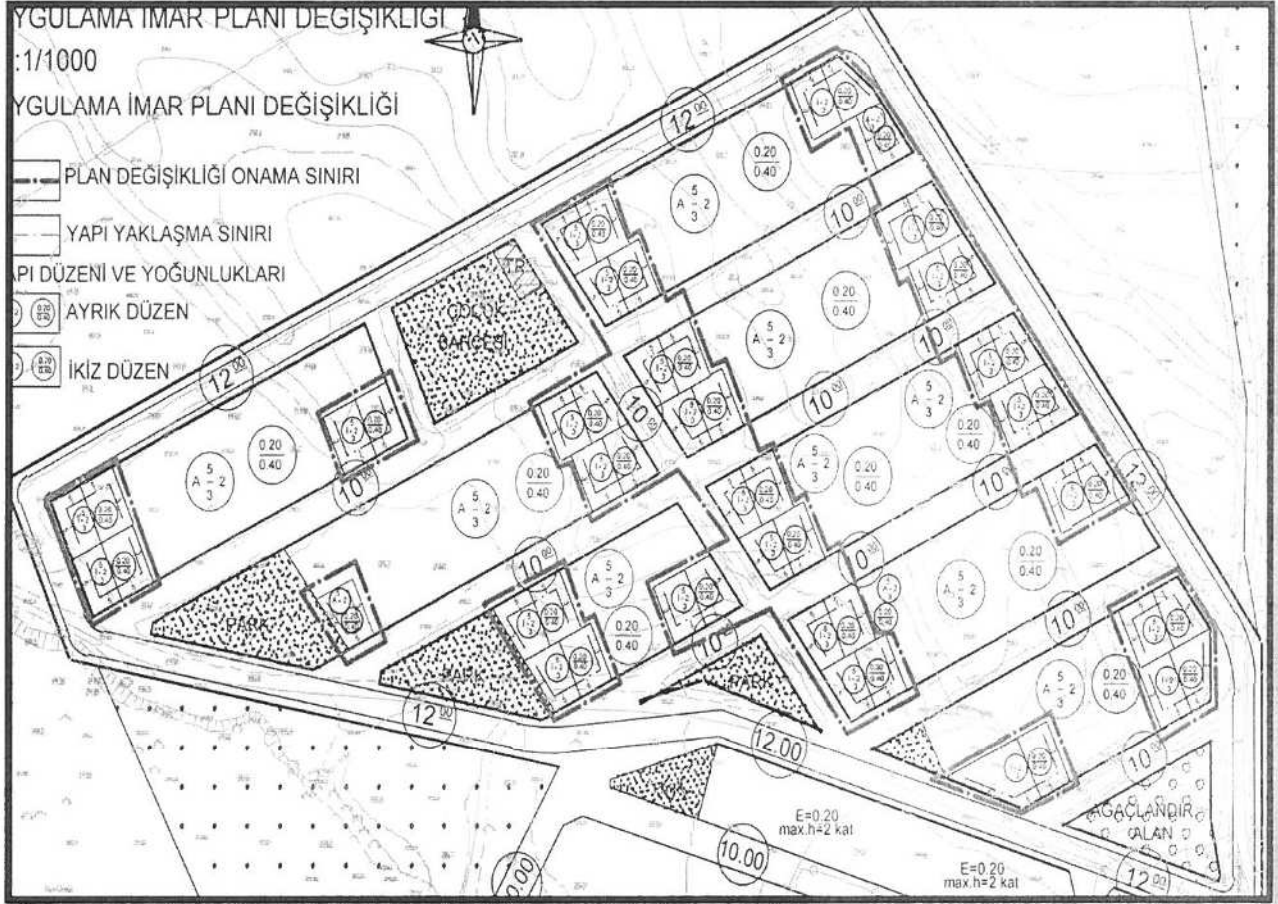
Ayrık Nizam yapılaşma plan kararı getirilen 184 Ada 30 parsel (Komşu çekme mesafeleri: 2,5-3 m)
